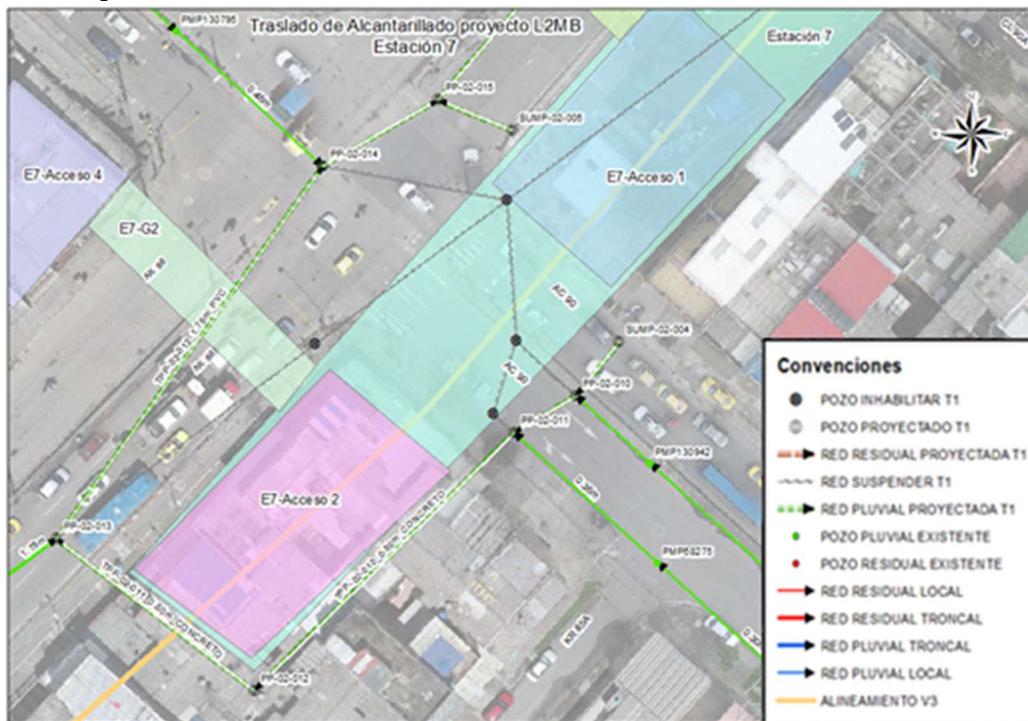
Traslado redes de alcantarillado Estación 7 Carrera 86 con calle 90 Red Residual
